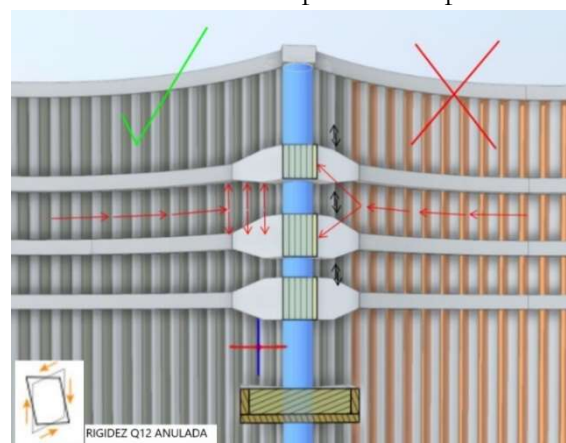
Transferencia de carga pantalla-*waler beam*. Sin esfuerzo rasante.
